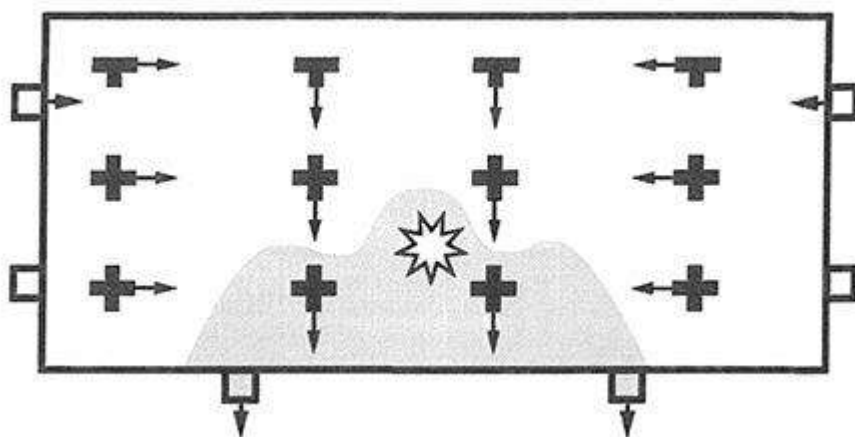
Схема автостоянки, оснащенной системой струйной вентиляции на базе центробежных струйных вентилято
